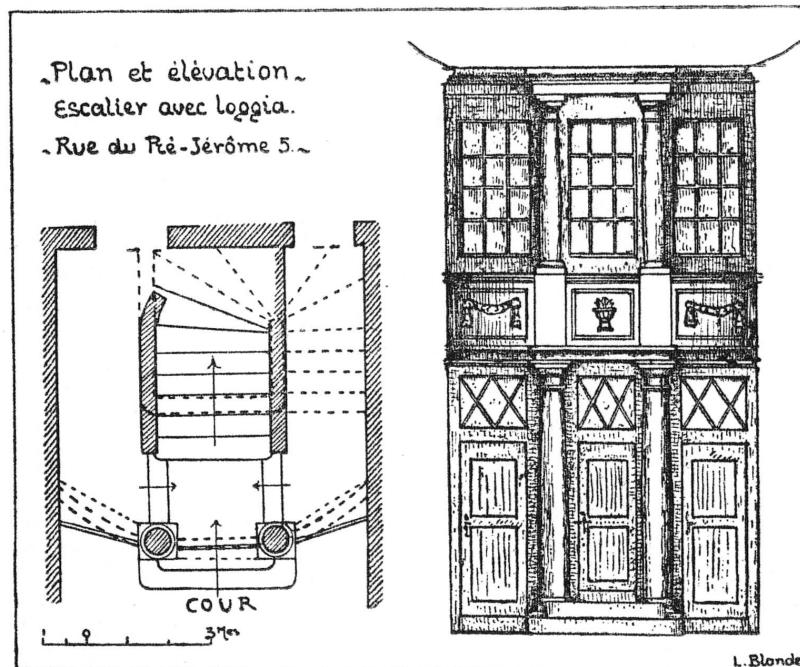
Plan et élévation de l'escalier avec loggia sur cour, rue du Pré-Jérôme 5.
